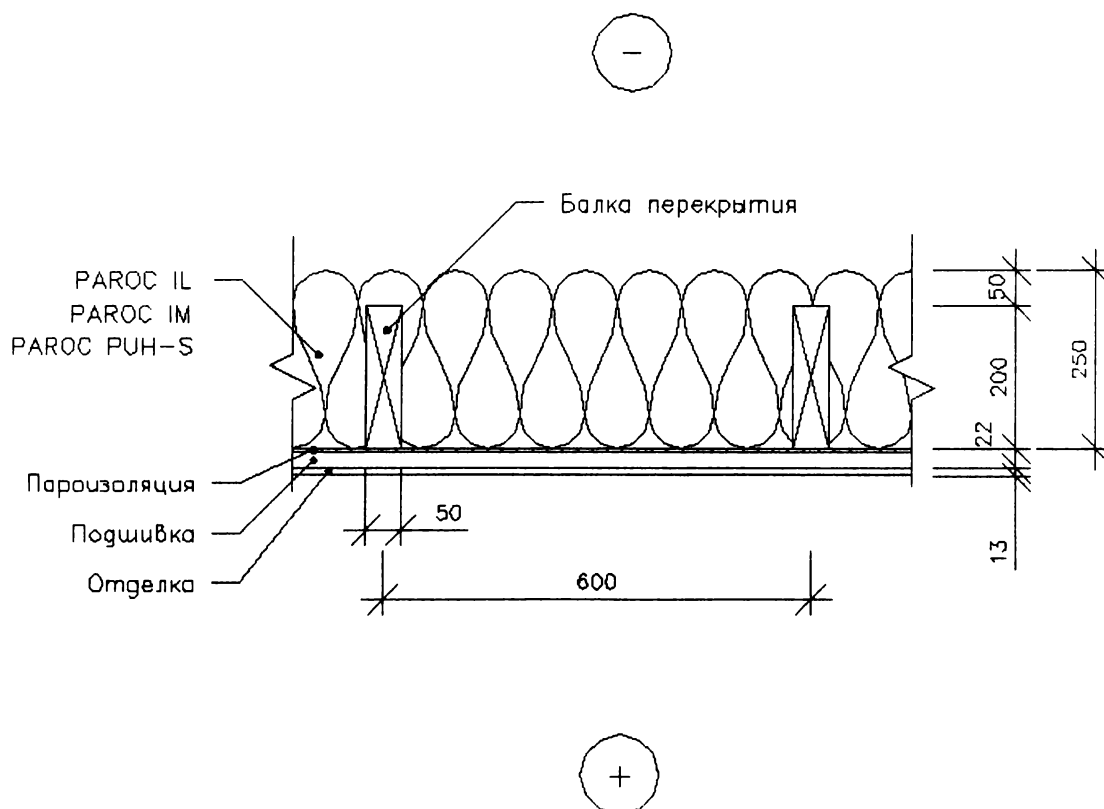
Утепление деревянного перекрытия при холодной мансарде
